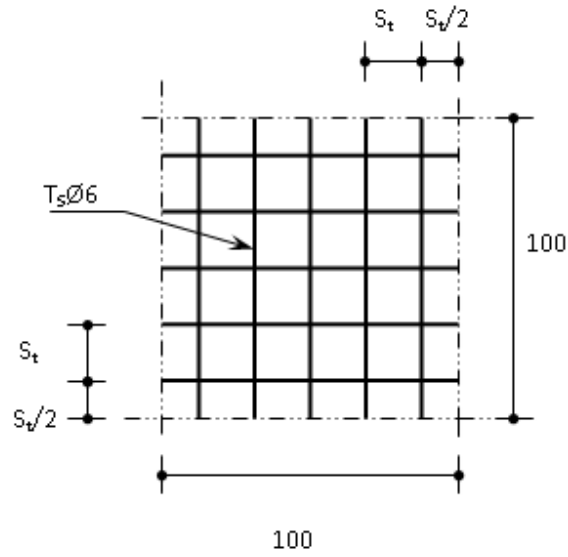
Disposition constructive des armatures de la dalle de compression
